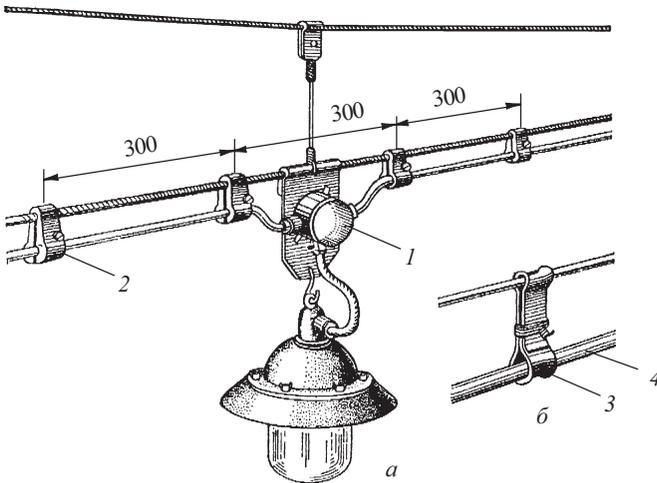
Подвеска кабеля на пластмассовых клицах и скобах на тросе:
